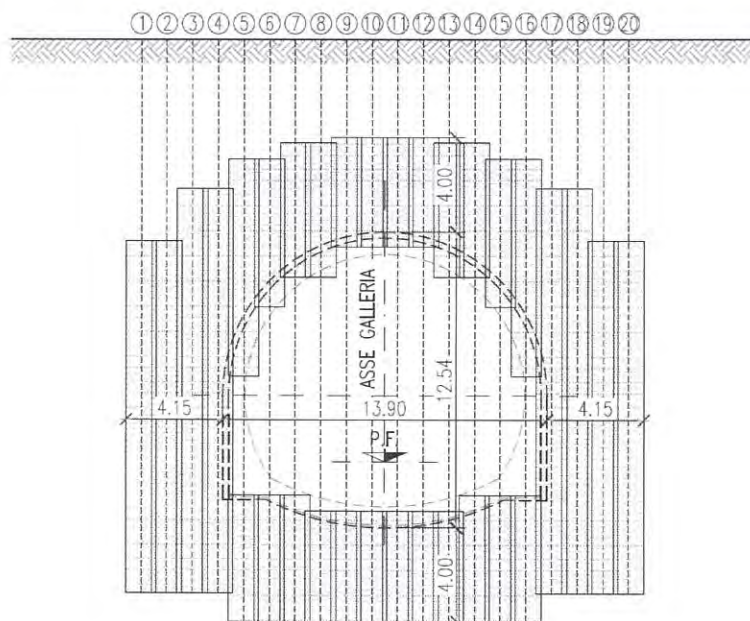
Sezione trasversale con indicato l'intervento di consolidamento ed impermeabilizzazione, mediante la tecnologia del jet - grouting, previsto lungo tutto il profilo di scavo, per eliminare ogni possibile impatto sulla falda.
